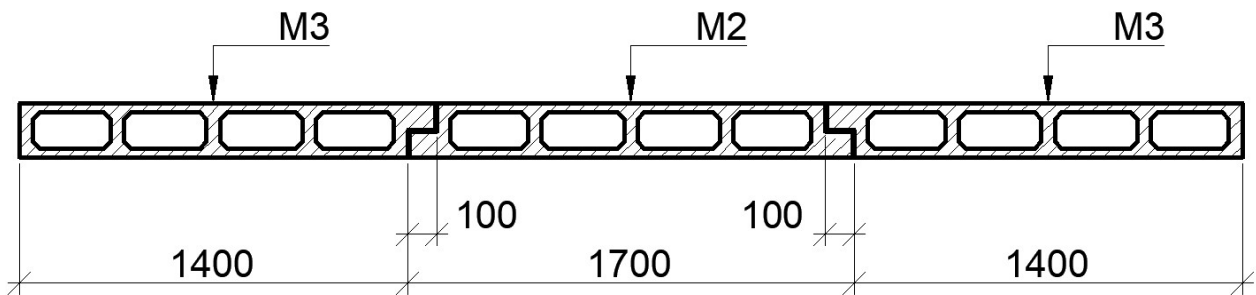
Загальний перетин дорожніх залізобетонна плита (елемент М2 та елемент М3) з внутрішніми восьми кутковими комірками.
